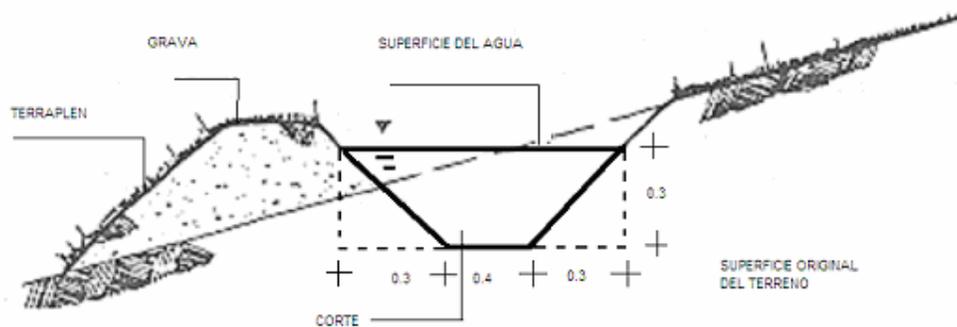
Propuesta de la sección transversal del canal trapezoidal
